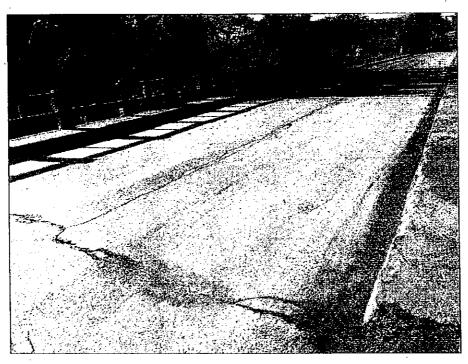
Vista superior evidenciando trinca no pavimento na região da junta longitudinal das obras.
